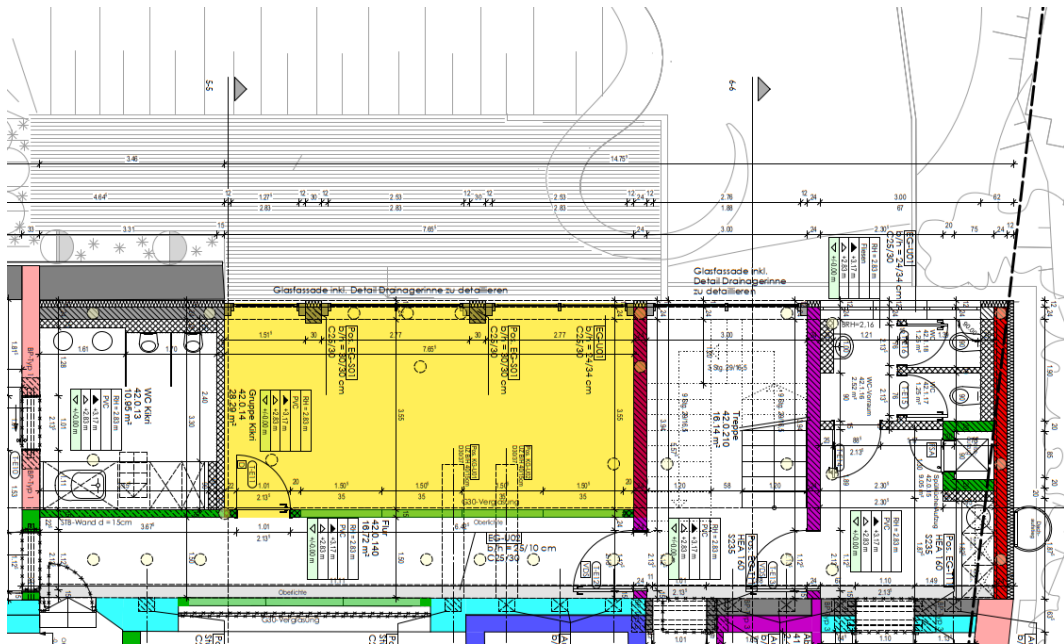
Grundriss EG mit untersuchtem Raum (gelb).
